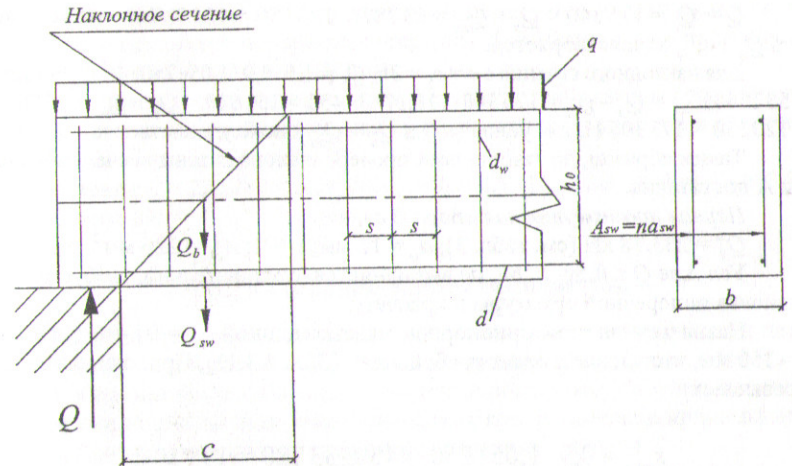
Схема усилий при расчете ригеля по наклонному сечению на действие поперечных сил
